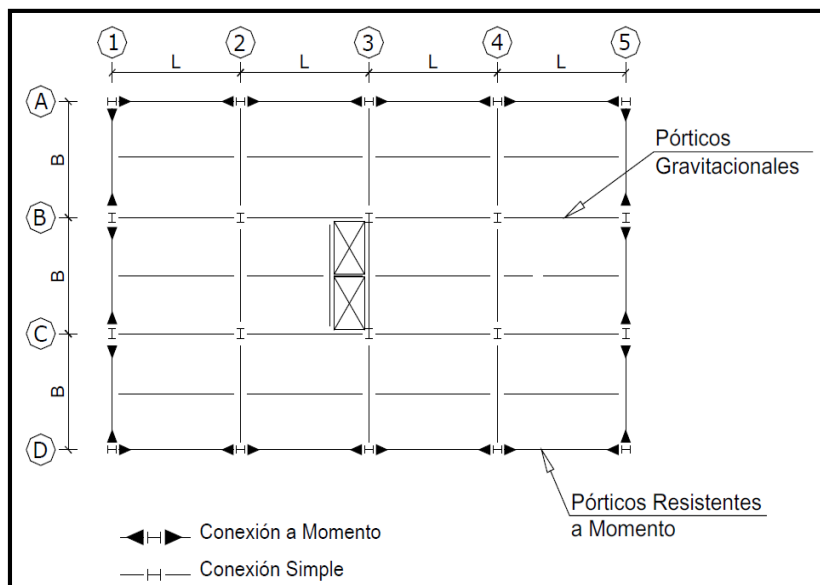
Planta de Edificio de Acero Estructural Compuesto por Pórticos Resistentes a Momento y Gravitacionales.
